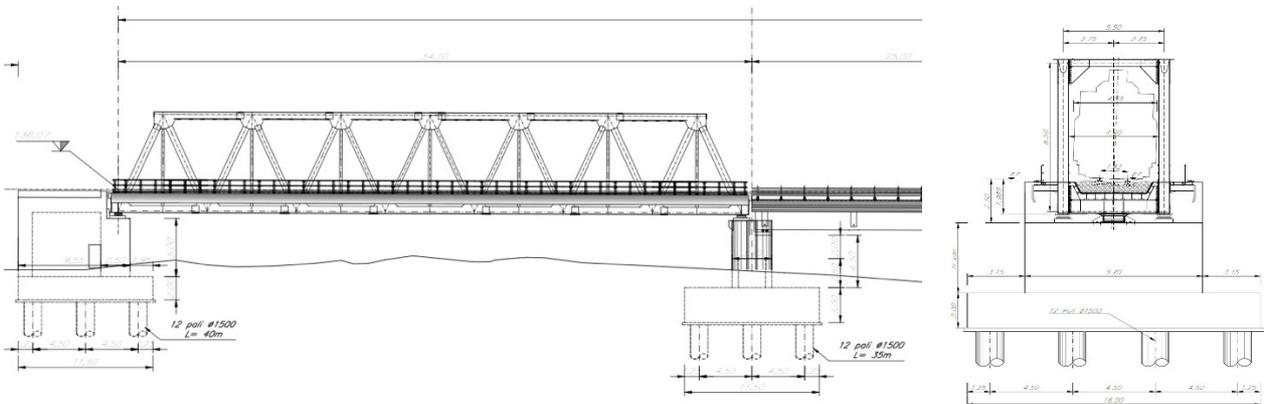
VI10 – Impalcato con travata reticolare metallica - Profilo longitudinale (sx) – Sezione trasversale (dx)
